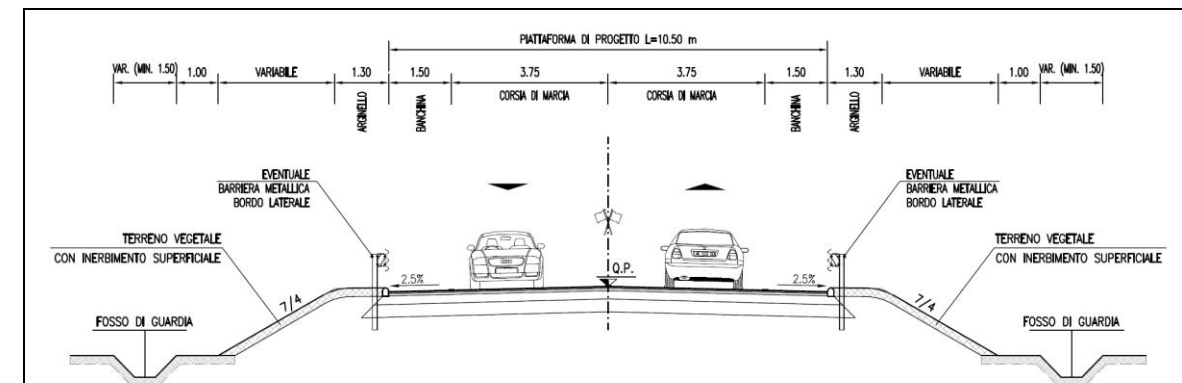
Sezione tipo rampa di svincolo bidirezionale
